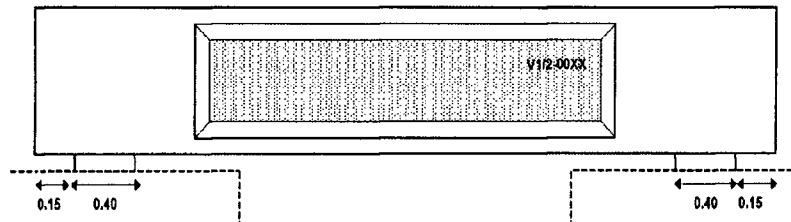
Detalle de apoyo de madera o similar para traslado en camión cama-baja o carreta.
